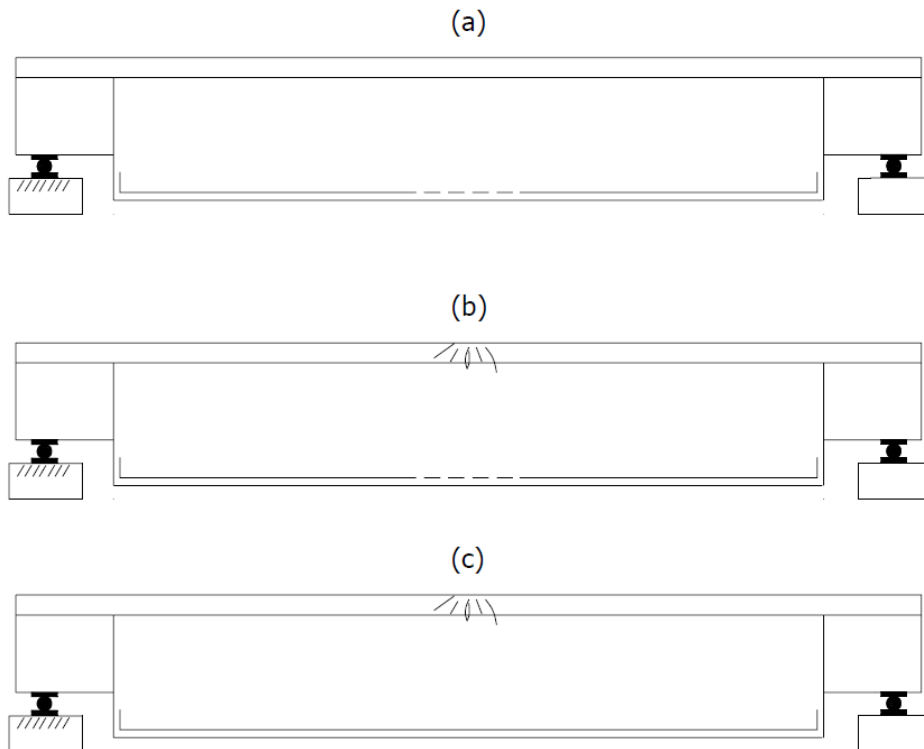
Modos de ruptura à flexão para vigas reforçadas por encamisamento.
